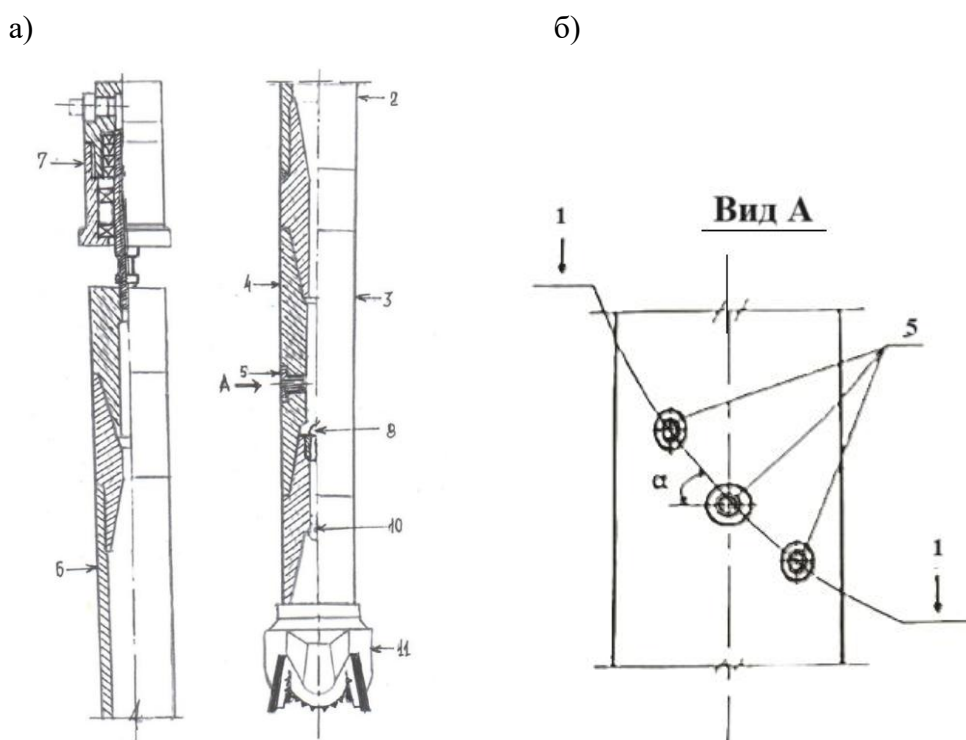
а) продольный разрез гидравлического монитора с соплами 2 -буровая установка; 3-лидерная скважина; 4- гидромонитор; 5 –сопла; 6 – трубы; 7 –сальник-вертлюг; 8- клапан; 9 – грунтоцементная шпонка; 10- обратный клапан; 11 – породоразрушающий инструмент; б) – вид А
